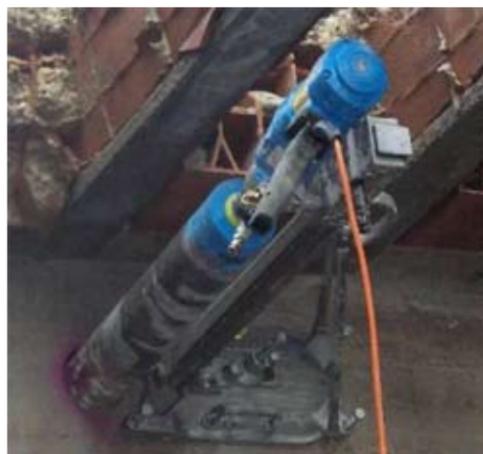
Attrezzatura per prelievo di carote. Si può osservare il motore elettrico (in primo piano, collegato al cavo arancione); il carotiere (a contatto con la struttura); la slitta (su cui è montata l'attrezzatura) già fissata sulla parete.
